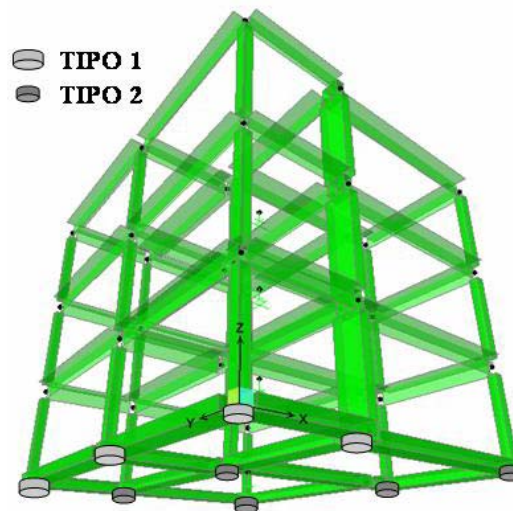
Disposizione in pianta dei due tipi di isolatori
